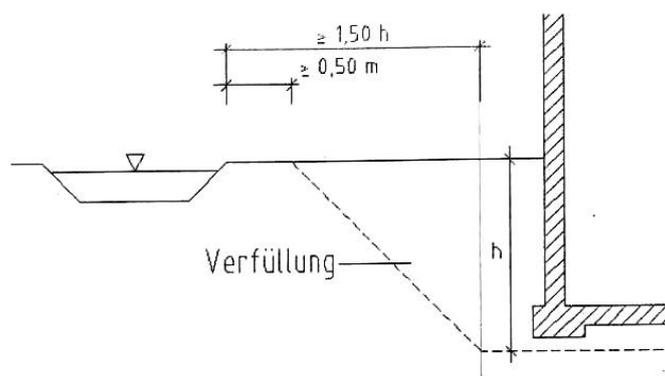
Mindestabstand dezentraler Versickerungsanlagen von Gebäuden ohne wasserdruckhaltende Abdichtung
